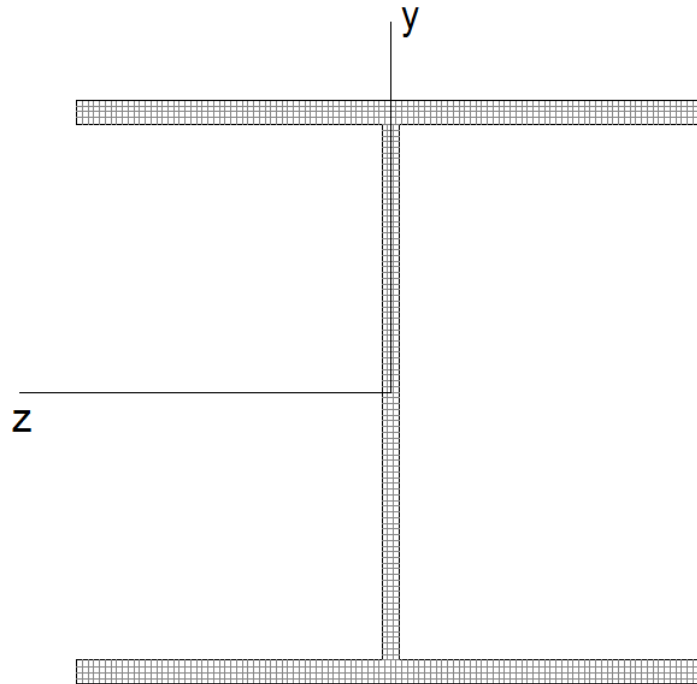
Perfil HE220AA com a subdivisão em fibras
